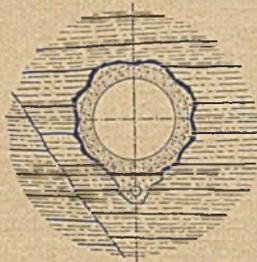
Horizontalquerschnitt durch einen Steigschacht im Ufer des Stausees; durchlässiges Gebirge; bei leerem Schacht äußerer Wasserdruck. Drainage geschlossen.
